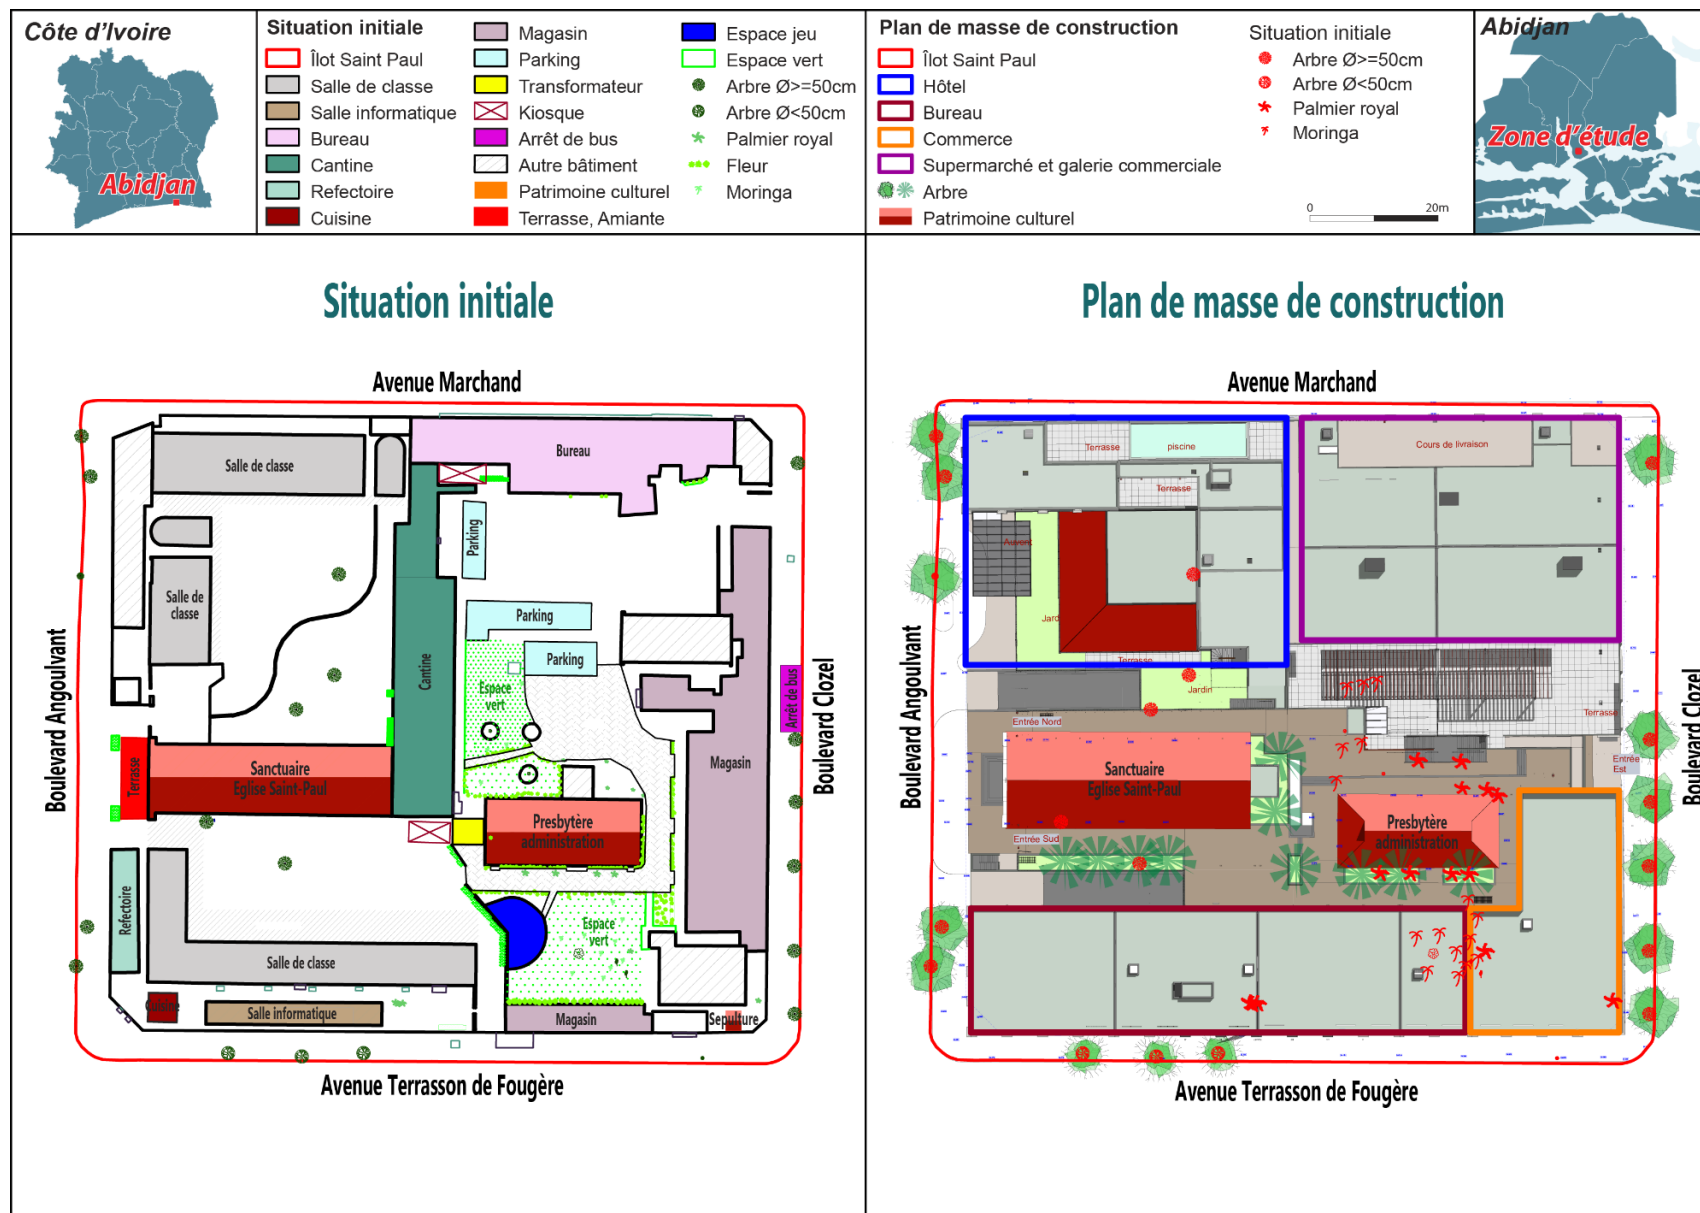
Comparaison entre la situation initiale et le plan de masse de construction du Projet
